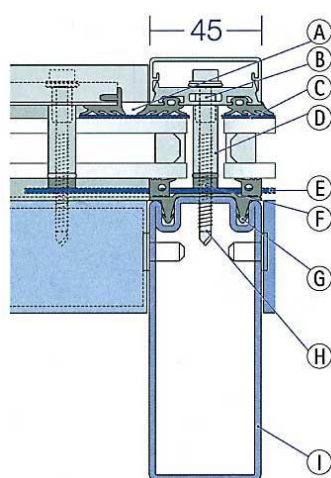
b. Sección corte de muro cortina de perfil de acero
